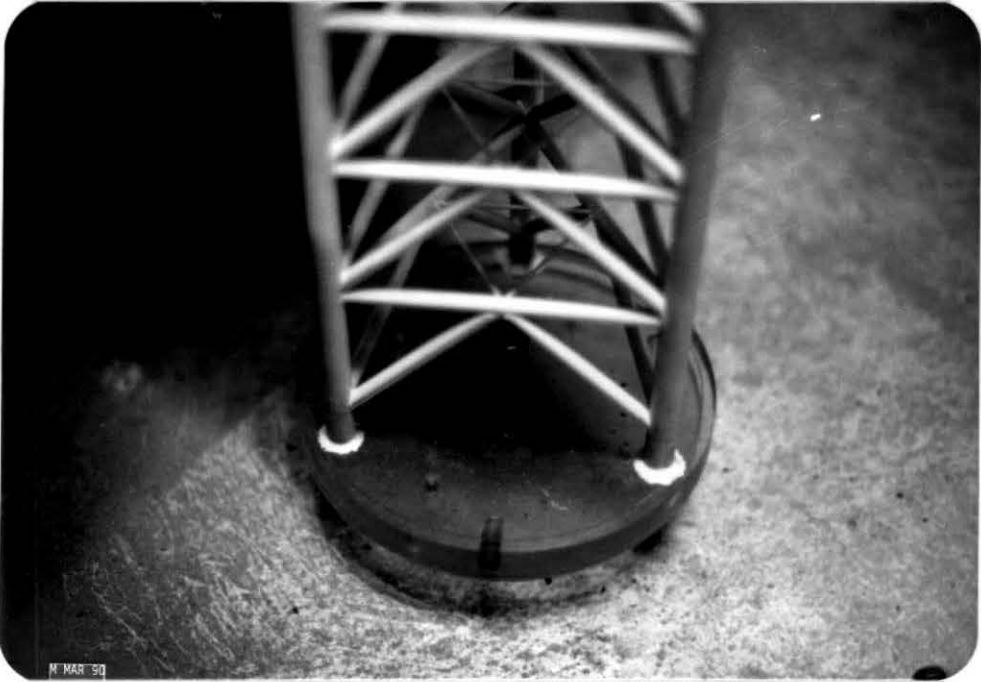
Detalhe do Apoio Inferior da Perna.
